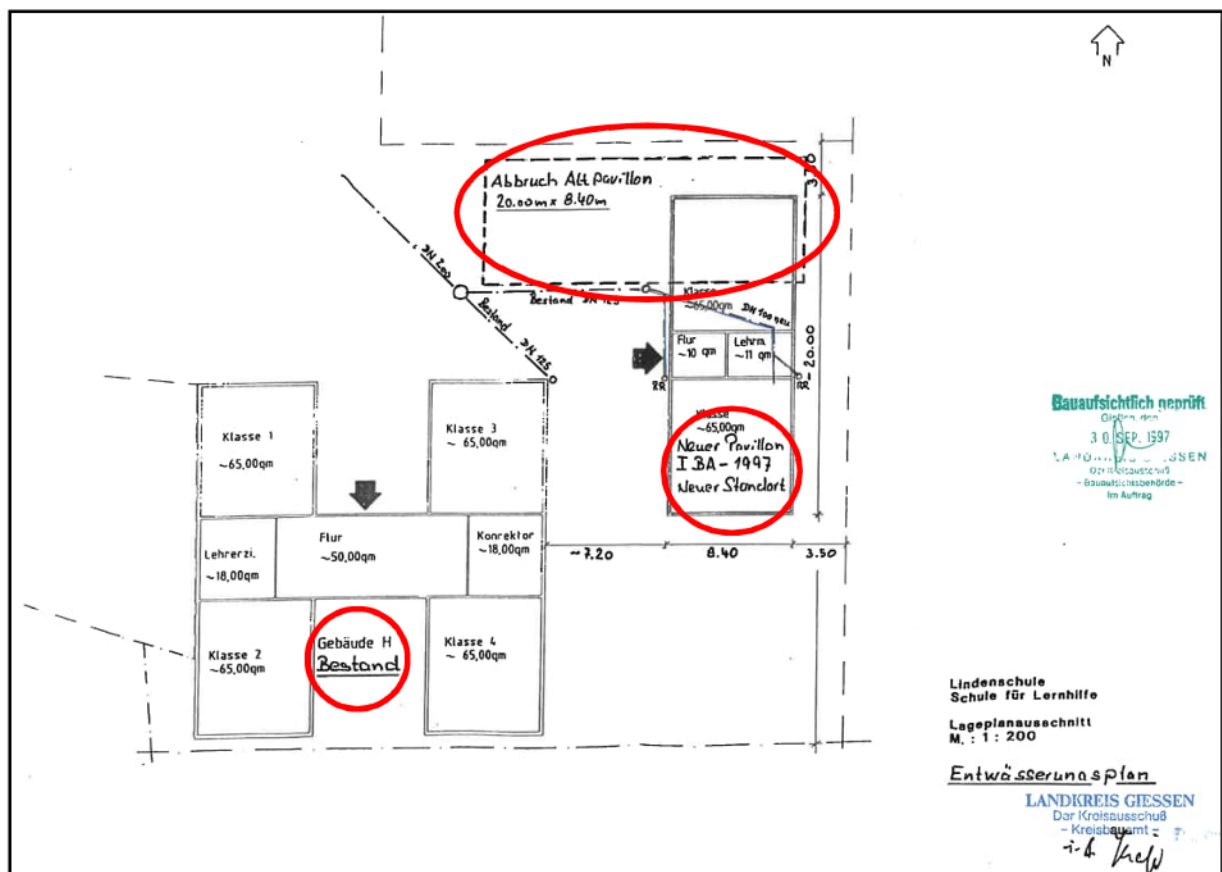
Entwässerungsplan mit Eintragung der rückgebauten / vorhandenen Gebäude
